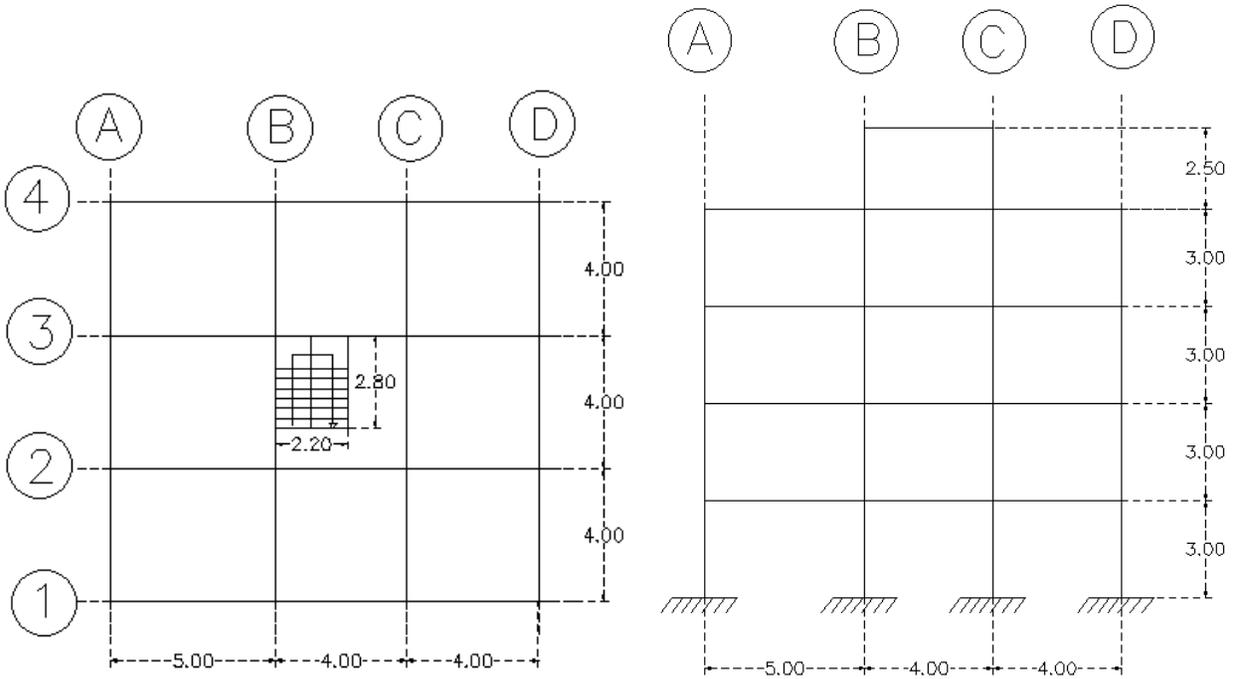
Vista en planta y elevación frontal de la edificación de cuatro plantas.
